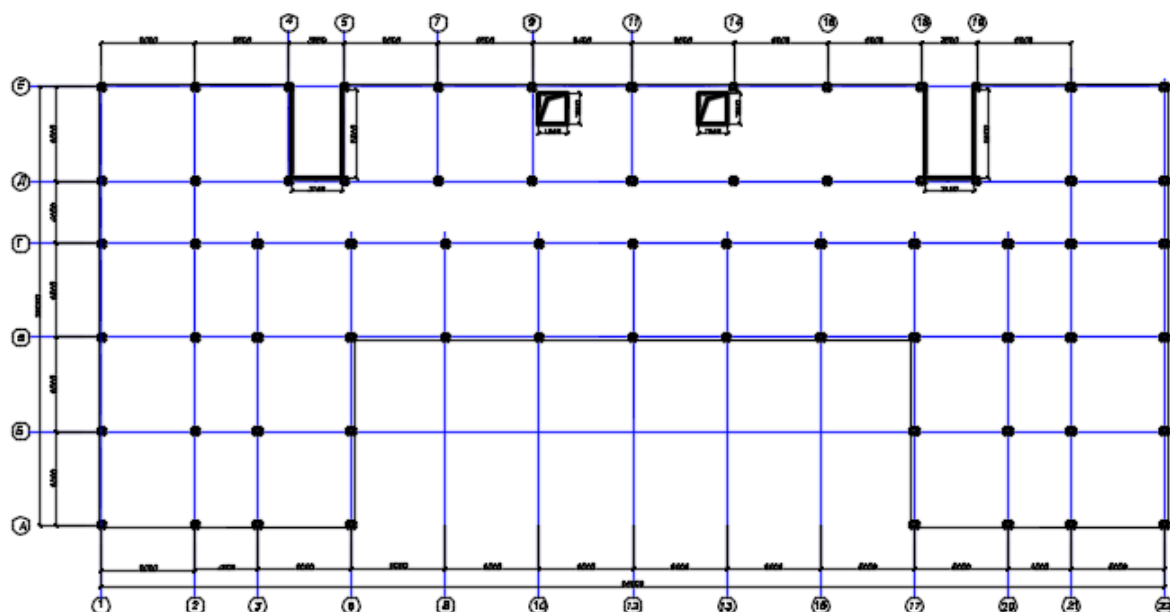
Компоновочная схема монолитного безбалочного перекрытия с сеткой колонн
